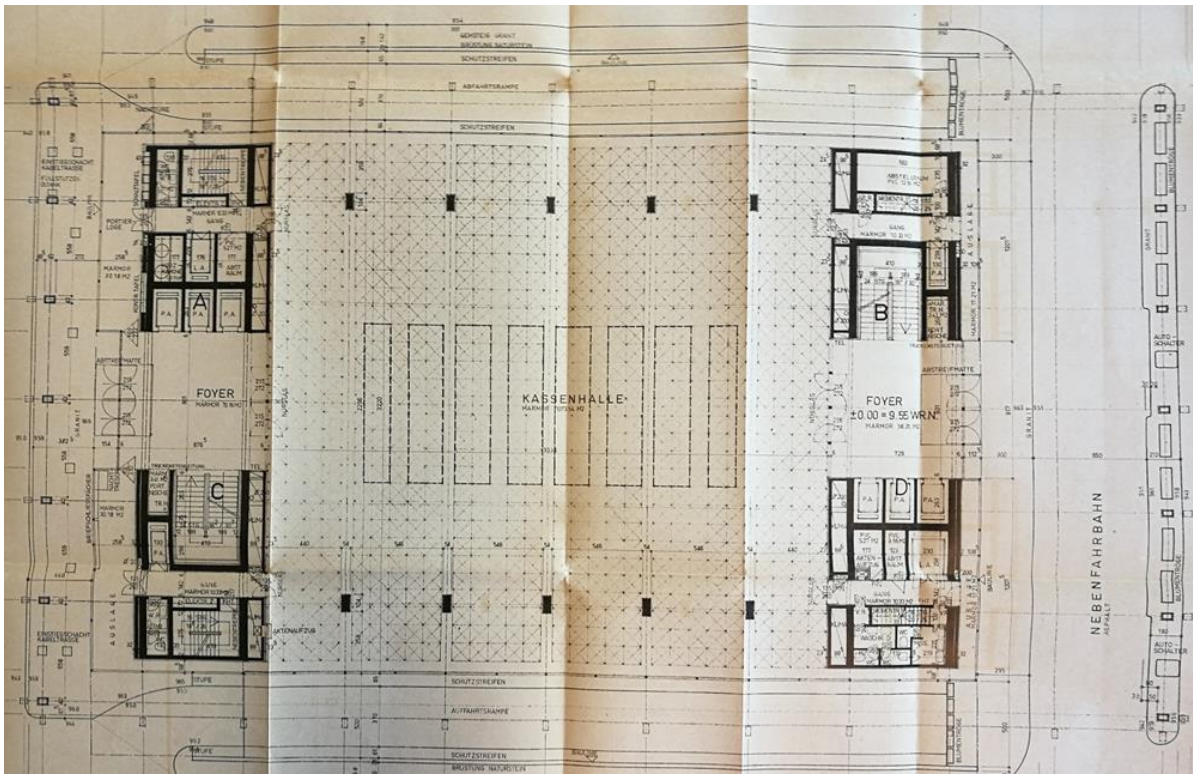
Grundriss Erdgeschoß, Ausführungsplan, Hauptanstalt Wien 3, Artur Perotti, 1965
